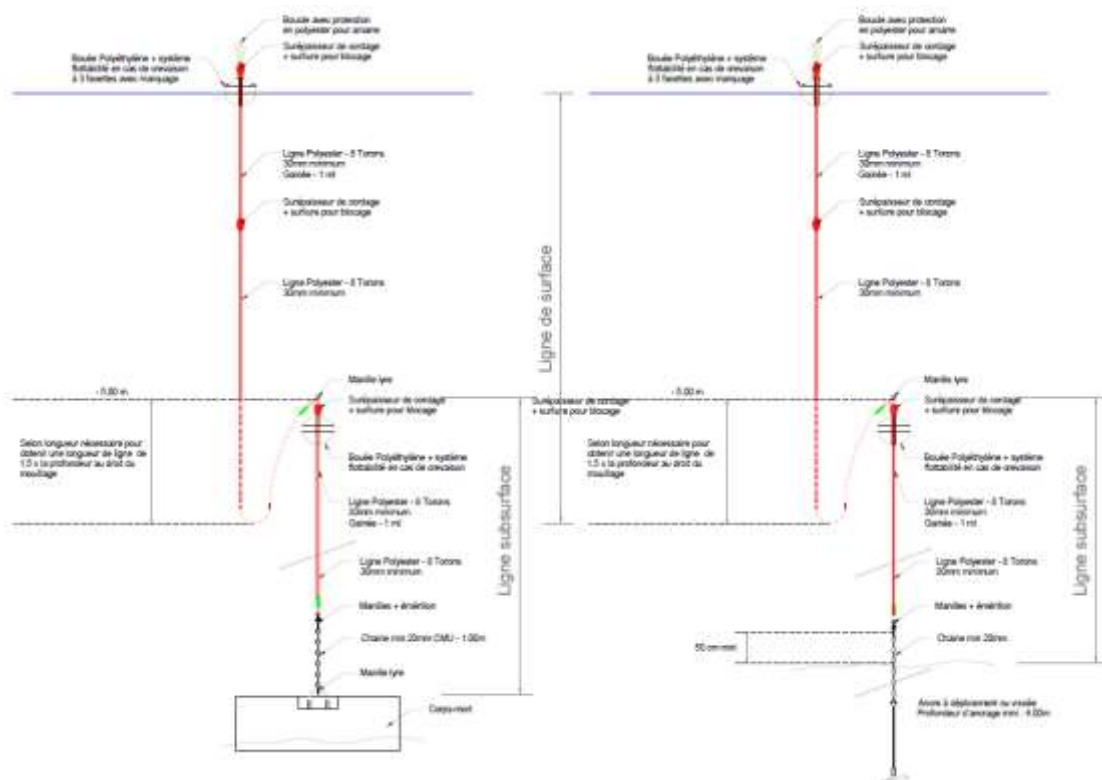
Plan type d'une ligne de mouillage et son ancrage
